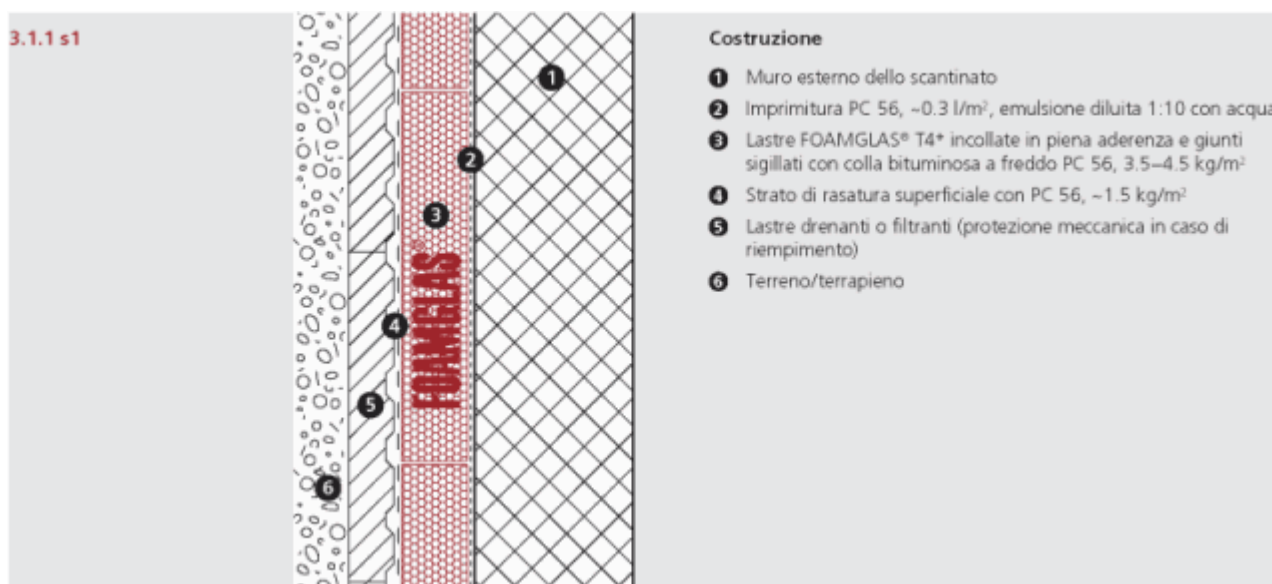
Tipologico intervento su muratura - parete su terrapieno.
